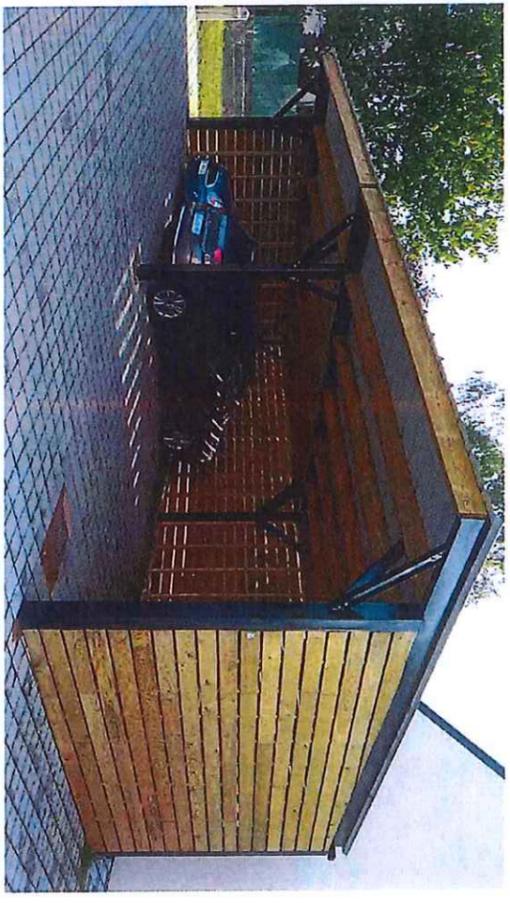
DETAIL DU MUR EN BOIS POUR BOITES AUX LETTRES
